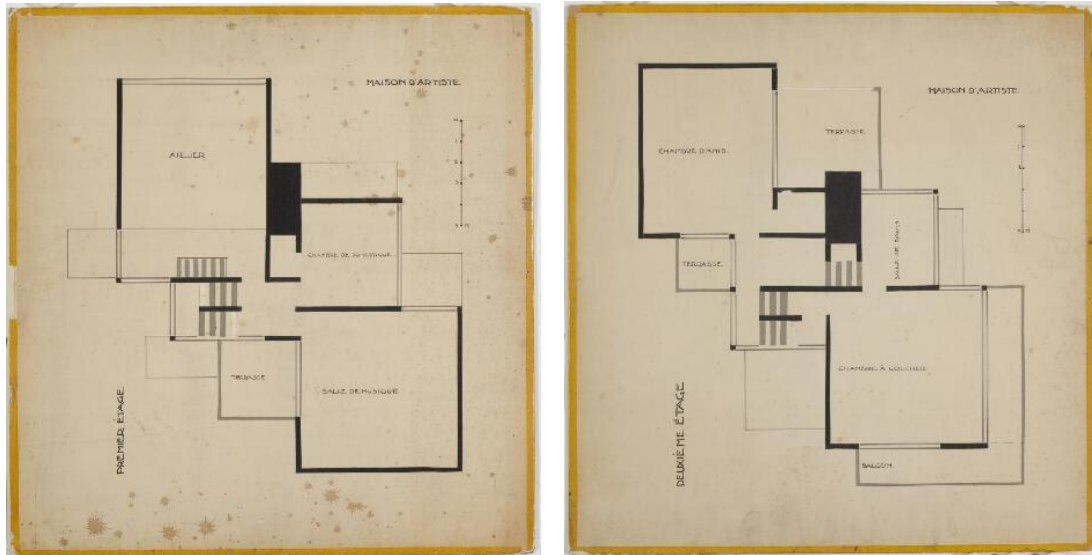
Planos de la planta 1ª y 2ª de la *Maison d'Artiste*, 1923. Fuente: HNI
